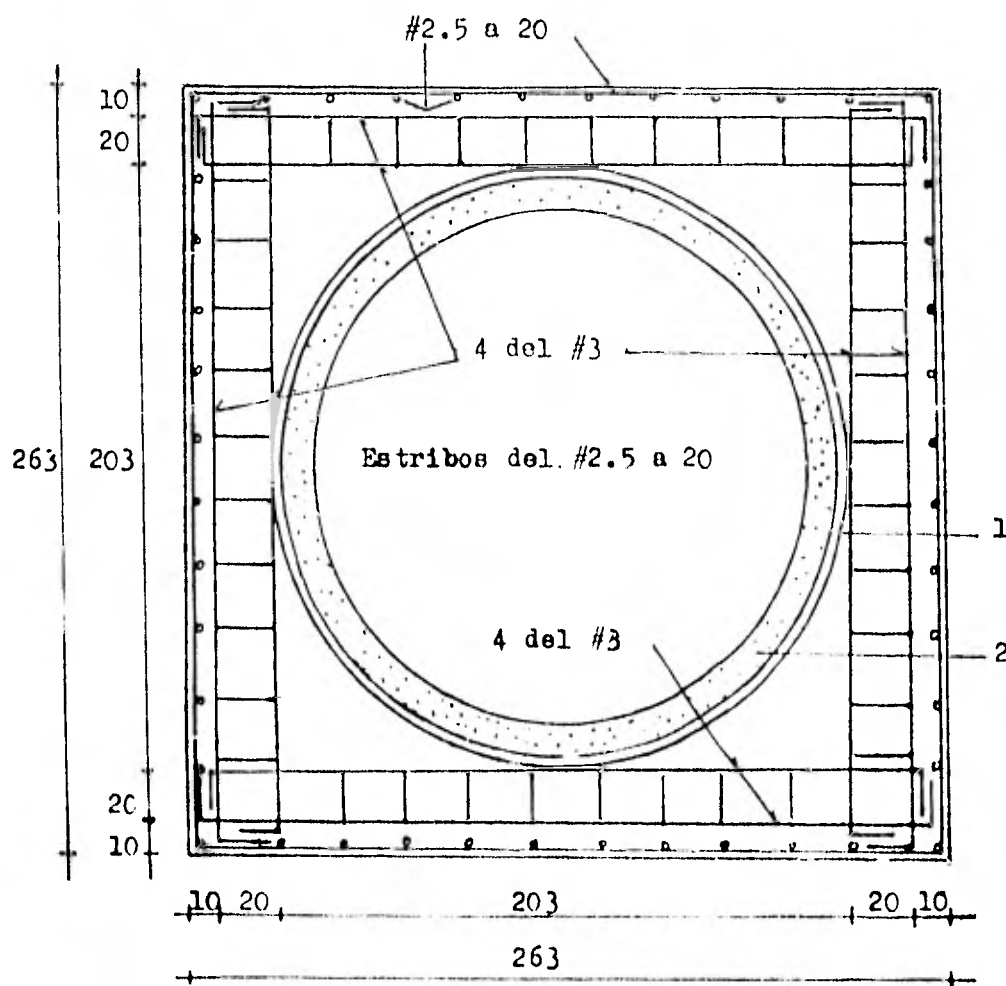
b Corte transversal que muestra el tipo de armado necesario para reforzar el dado de unión.
